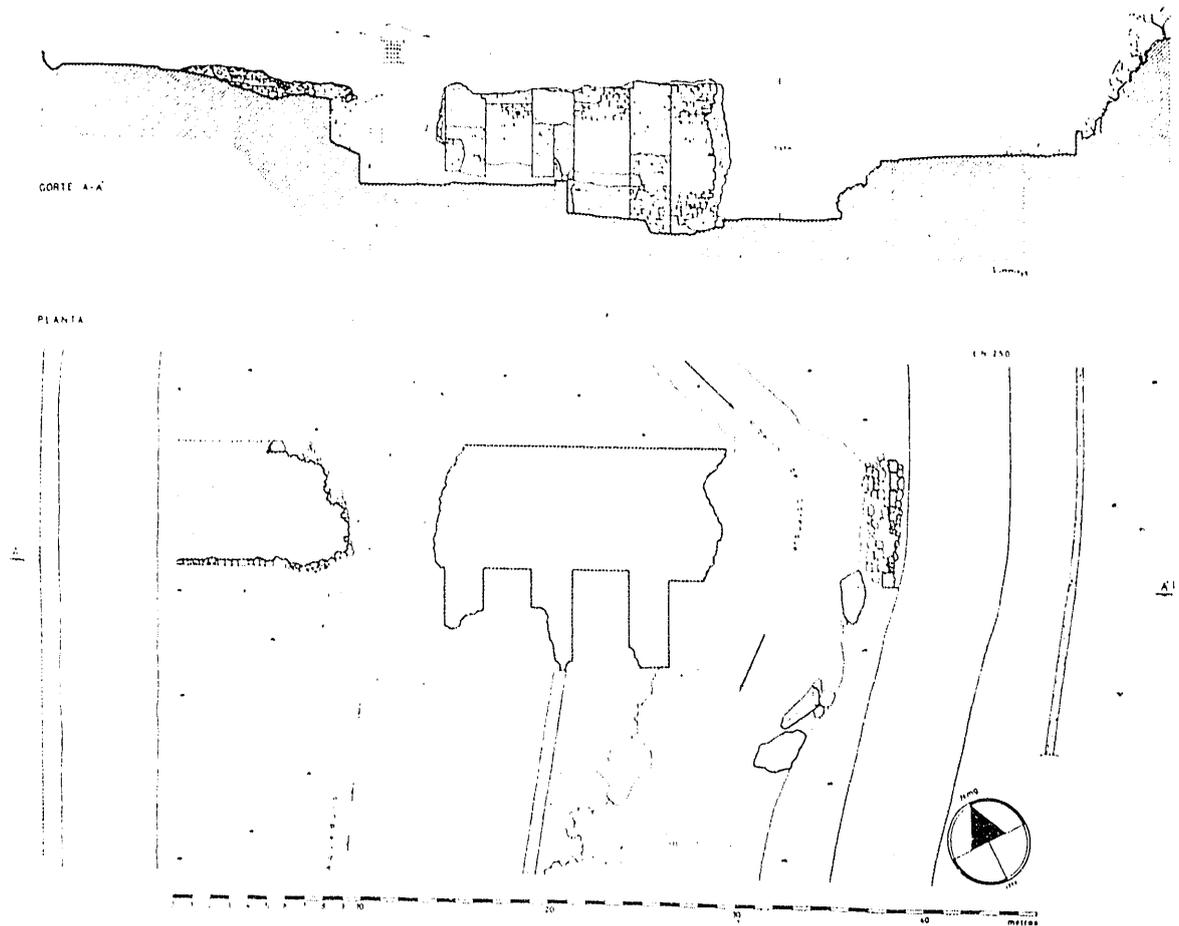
Presa de Olisipone (Lisboa). Alzado y planta.
